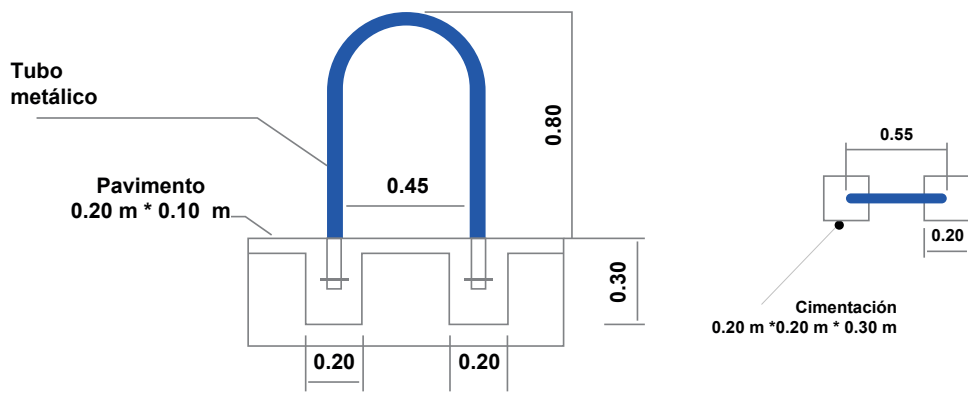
Plano de detalle para tubo de cicloparqueaderos
